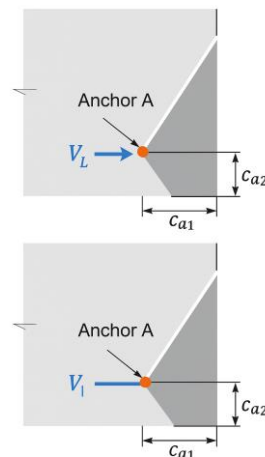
Cortante paralelo a un borde. Tomado de *Building Code Requirements for Structural Concrete (ACI 318-19)*, por American Concrete Institute, 2019. Copyright 2019 por American Concrete Institute.
